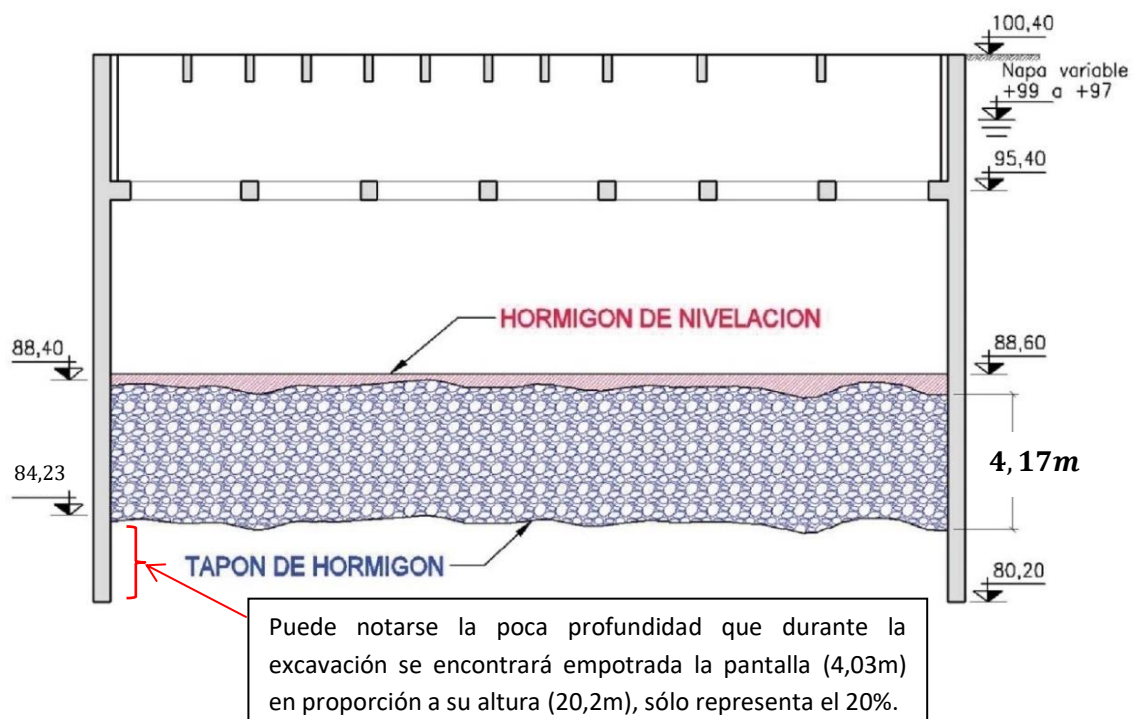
Propuesta Nº1: Tapón de Hormigón, escasa ficha durante excavación
